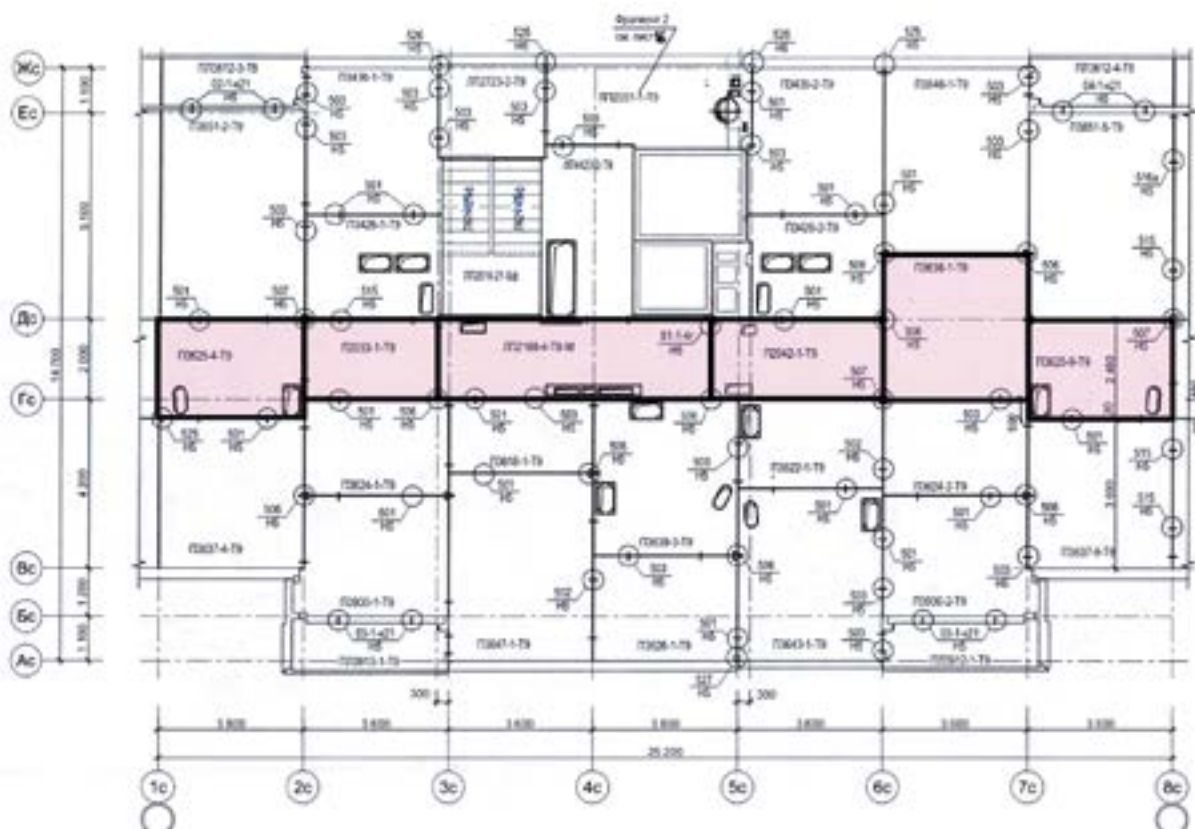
Существующая раскладка плит перекрытий блок-секции «Дом НАД»
